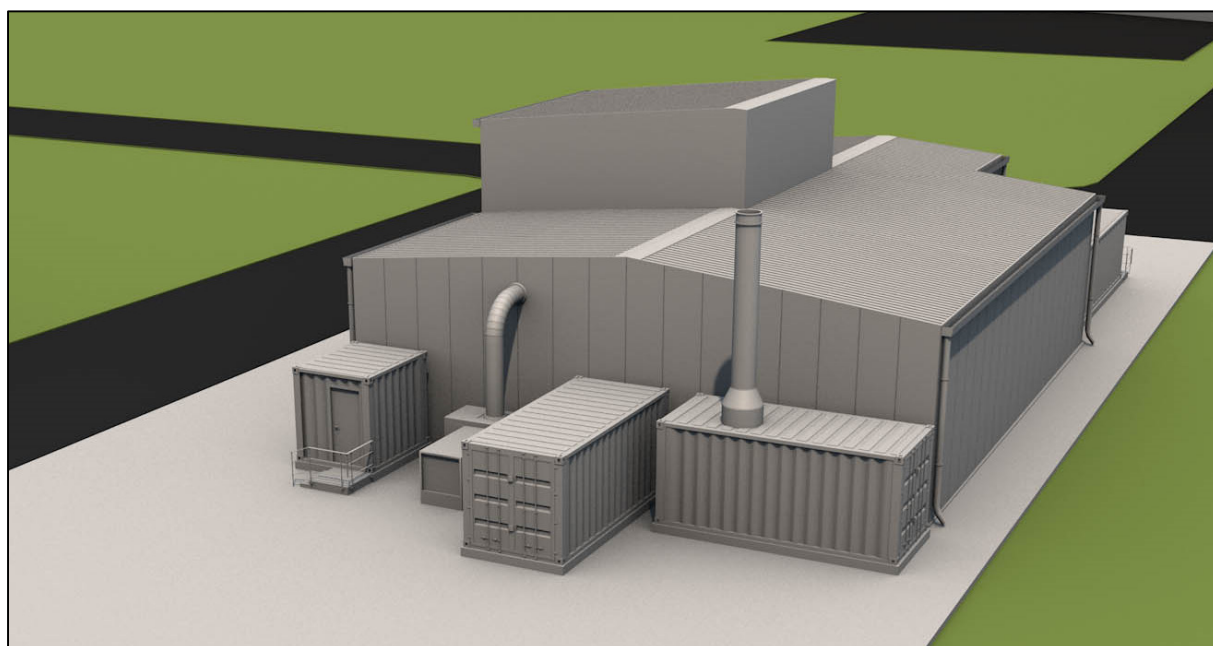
Impianto SiCoMoR – prospetto Sud - Ricostruzione 3D
